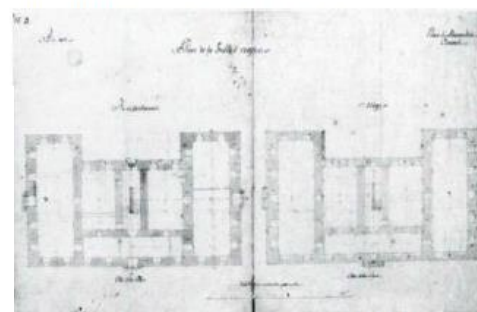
Pianta piano terreno e primo del quartiere Sant'Antonio, 1812.
